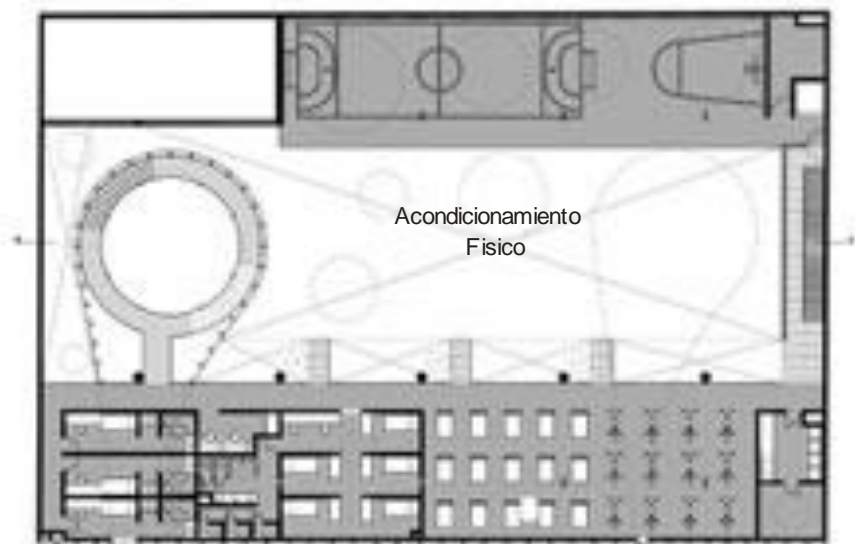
Planta tercer nivel, de cuartel y acondicionamiento físico
